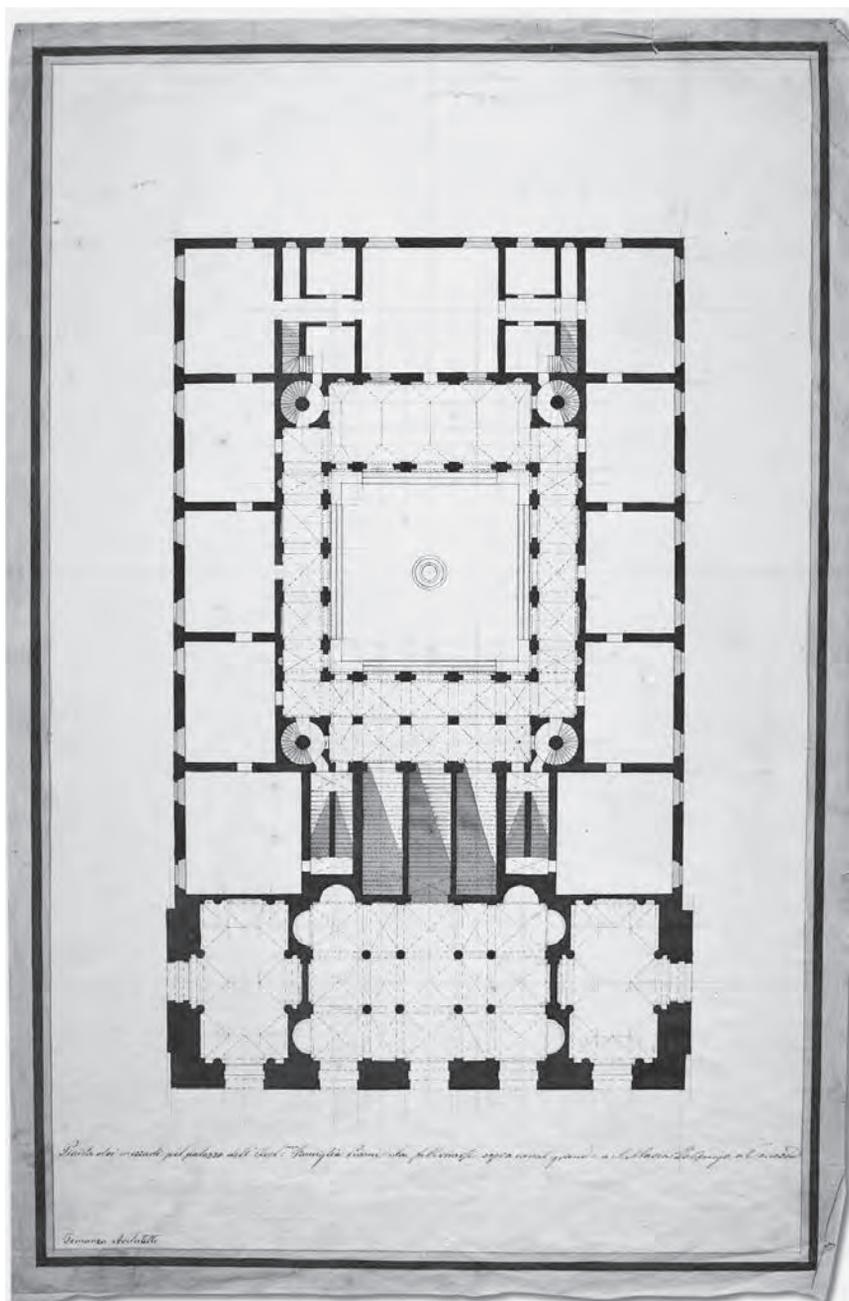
T. TEMANZA, *Progetto per Palazzo Pisani a Santa Maria del Giglio sul Canal Grande, pianta del primo piano*, Venezia, Museo Correr: Gabinetto stampe e disegni, cl. III, n. 6083, disegno.
